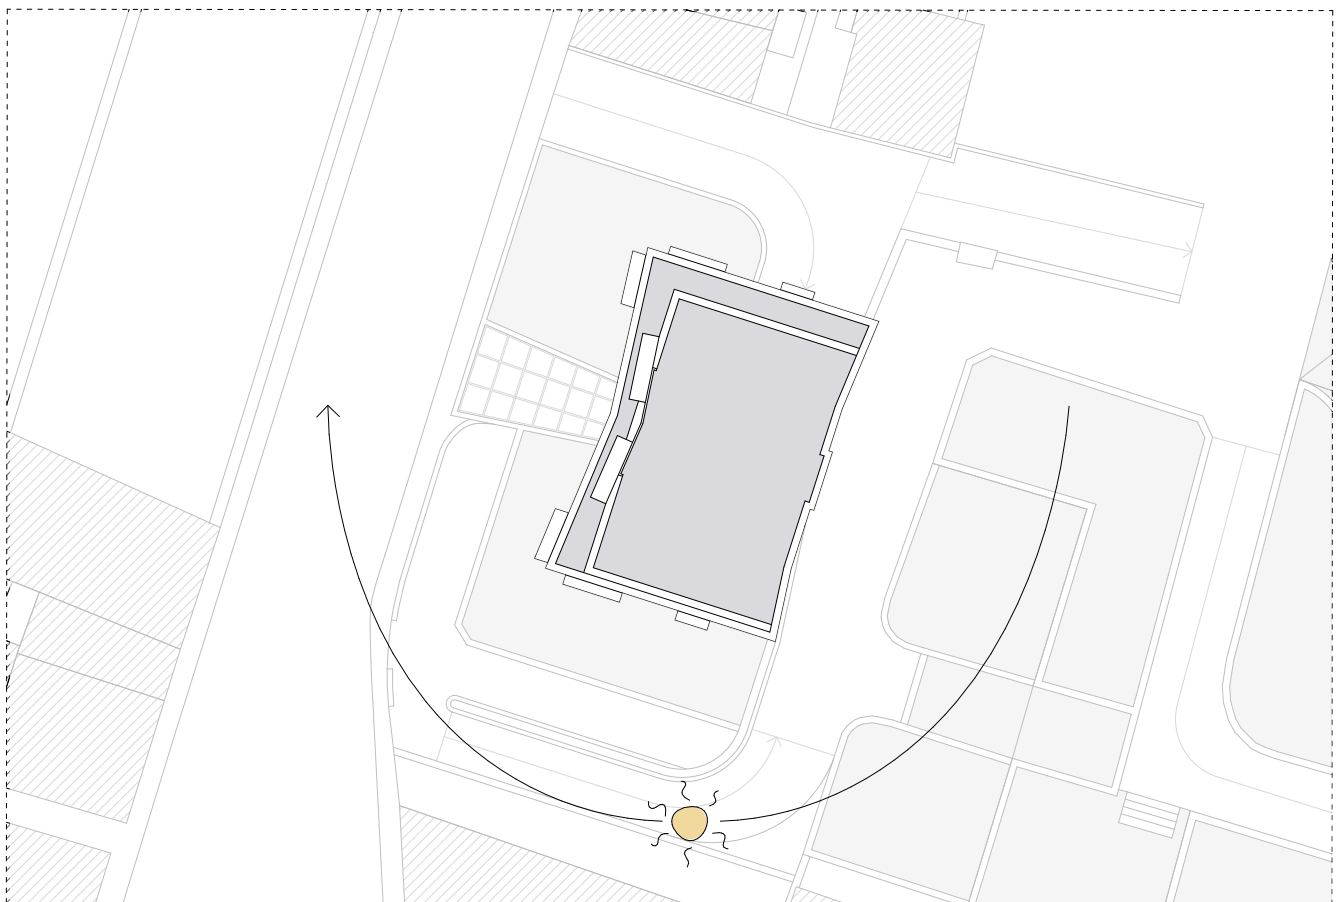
Esquema da Planta de Implantação da Torre do Miradouro e orientação solar, escala 1:500
